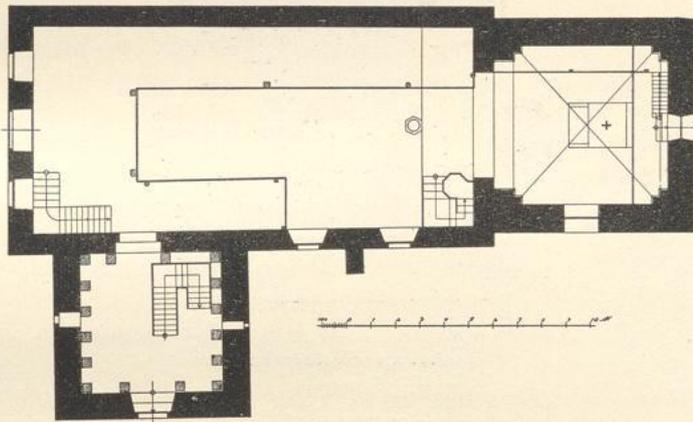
Kirche in Wilkenburg; Grundriss.
